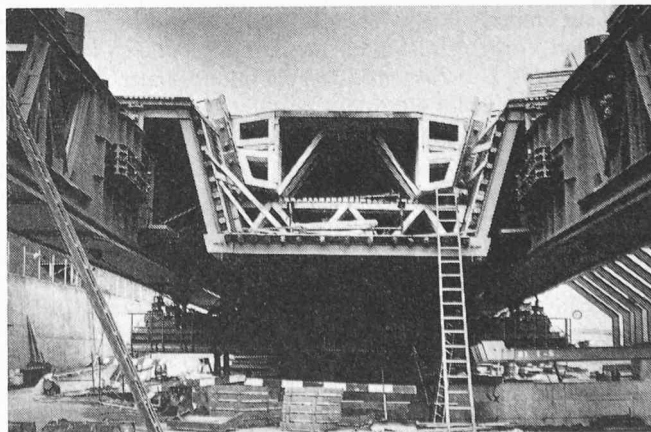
Vorschubgerüst nach der ersten Vorfahrt. Hinten im Bereich des betonierten Brückenfeldes der rückwärtige Fachwerkschnabel. Dann folgt der kastenförmige Rüstträger, der an der Koppelfuge aufgehängt ist. Vorne ist der 46 m Vorfahrschnabel mit Auflagerung auf der Quertraverse beim Pfeiler 4. Auf dem betonierten Teil sind 5 m lange Elemente der klappbaren Innenschalung zu sehen (Aufnahme: D. J. Bänziger, 21. 7. 1977)
